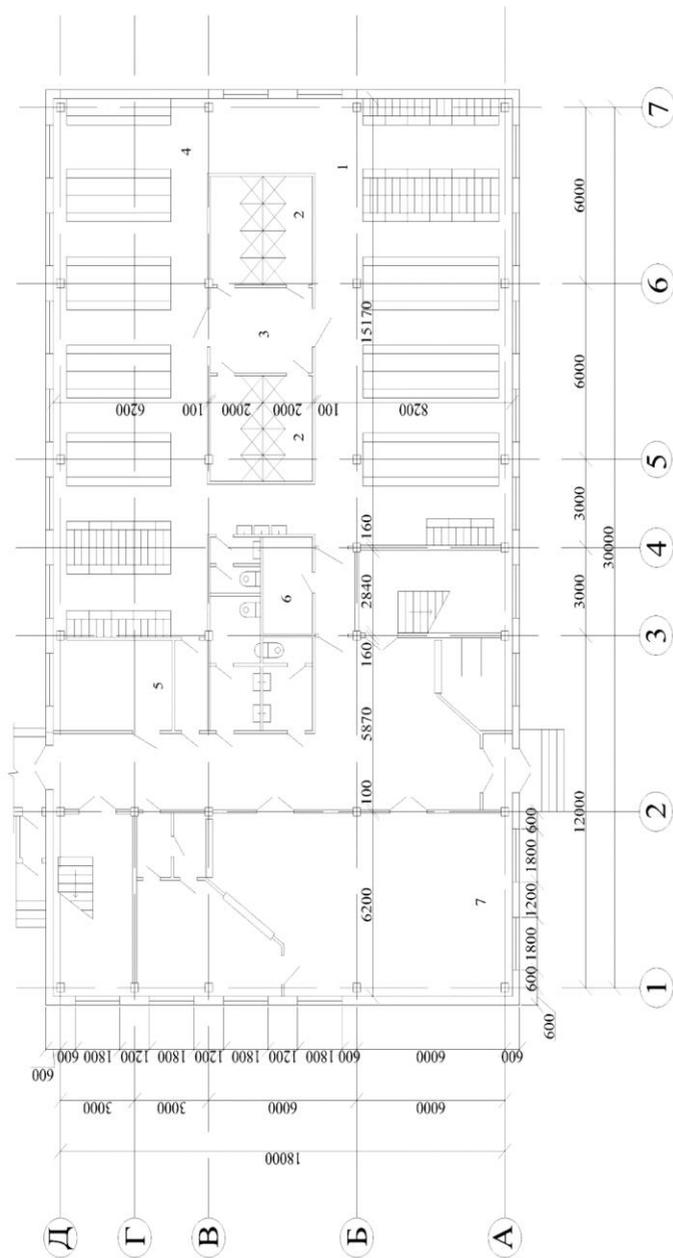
Пример решения плана 1-го этажа каркасного административно-бытового здания:
